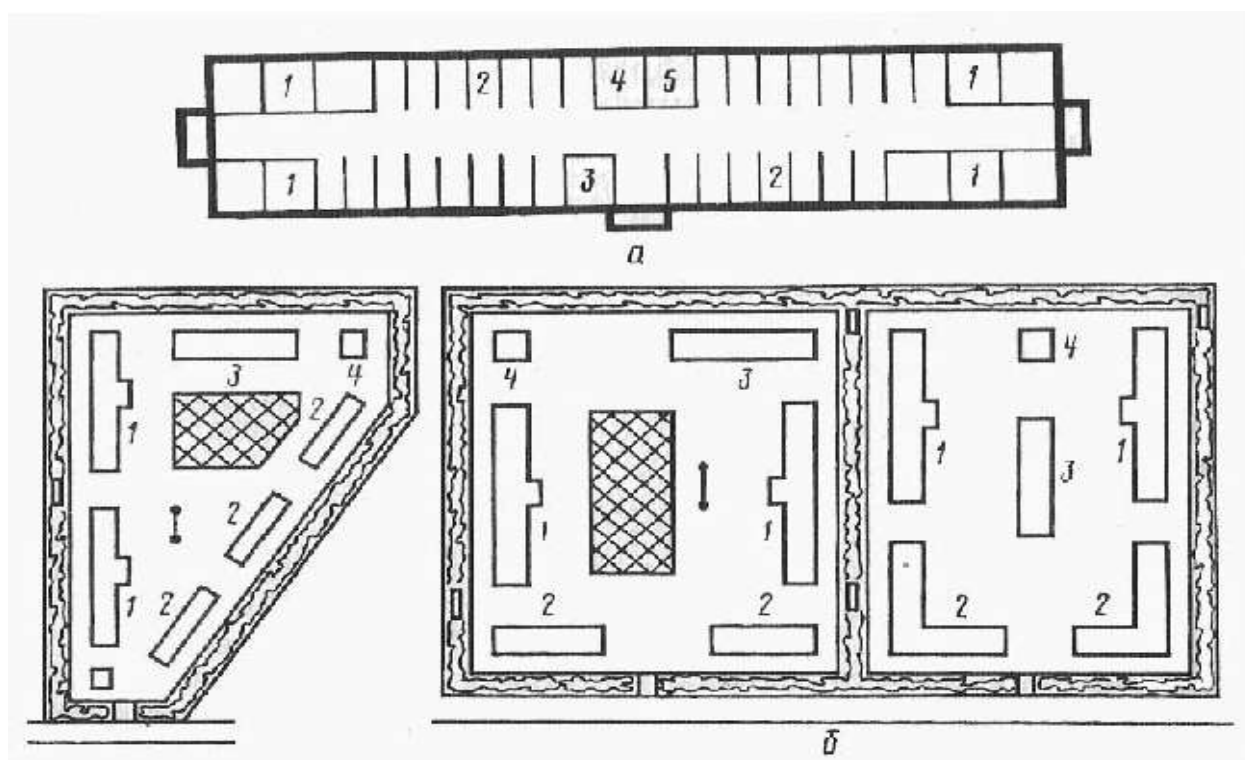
Конный рабочий двор: а — конюшня на 40 рабочих лошадей: 1 — денники; 2 — стойла; 3 — дежурное помещение; 4 — фуражная; 5 — инвентарная; б — варианты планировки конного рабочего двора: 1 — конюшни; 2 — сараи для транспортного инвентаря; 3 — склад кормов; 4 — кузница
